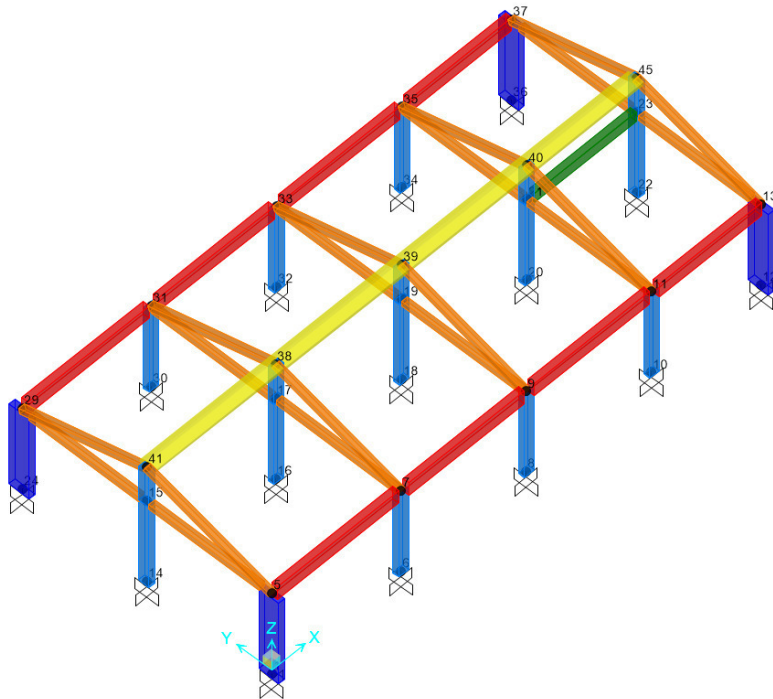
Vista assonometrica modello struttura in elevazione - elementi estrusi
